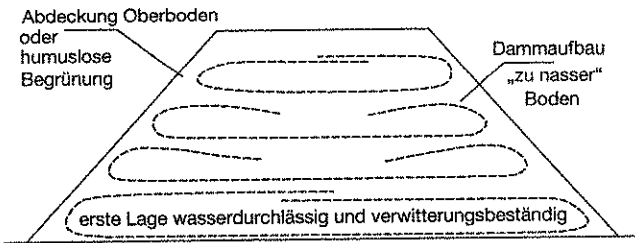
Aufbau eines Dammes in Sandwichbauweise mit Vliesstoffen
